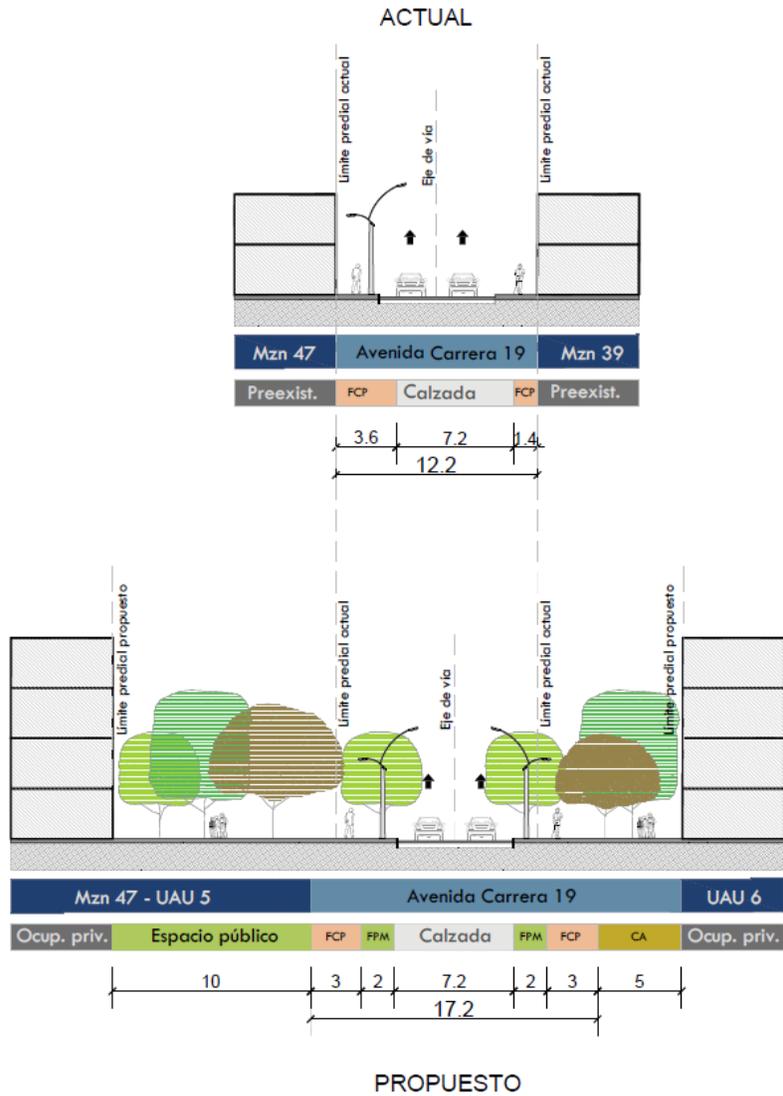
Perfil Avenida Carrera 19 entre Cementerio Central y la Calle 24
